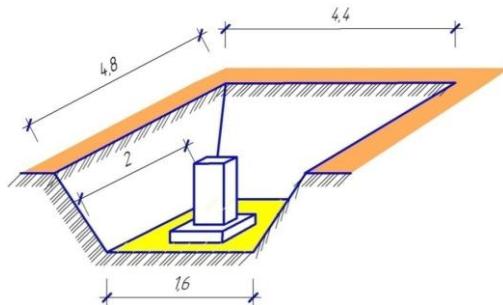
Котлован-яма под отдельно стоящий фундамент
